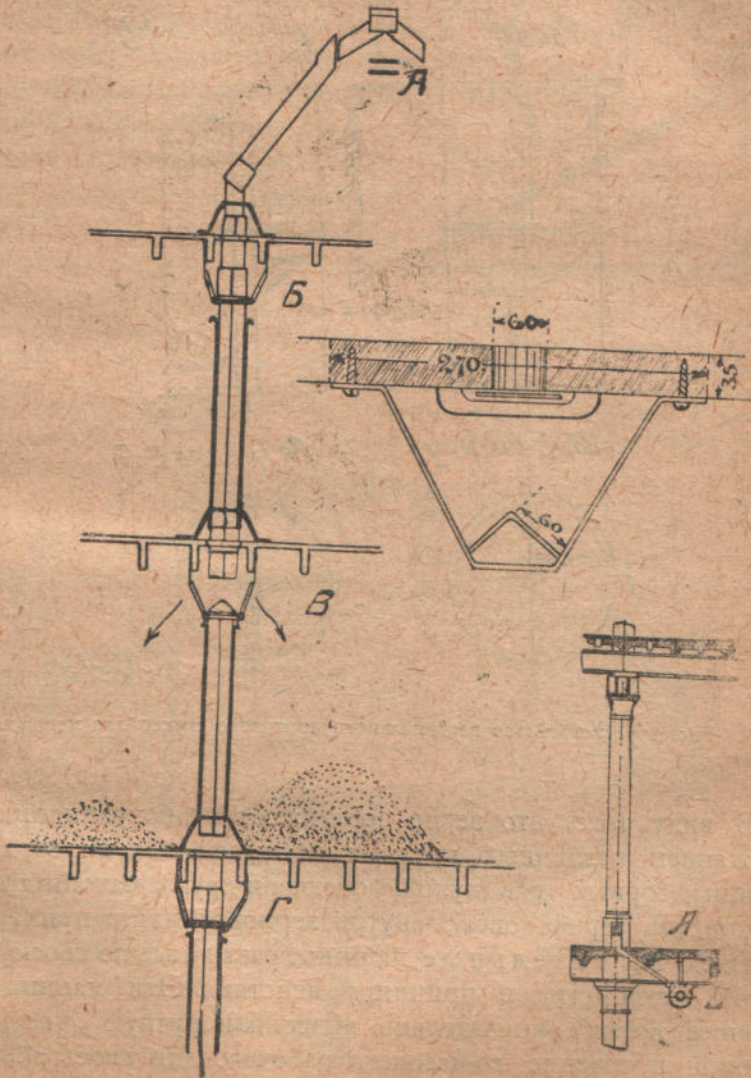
Общее устройство внутренних спусковых труб для передачи зерна с одного этажа на другой и деталь выпуска из них в полу этажного элеватора. Обозначение букв: А—конвейер, Б и Г—закрытые выпуски в этажи; В—открытый выпуск в этаж.
